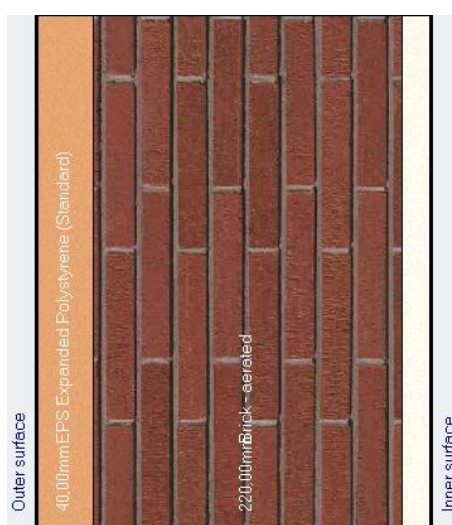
Materiais usados na parede como visto no *DesignBuilder*: isolamento na parte externa, depois tijolo e reboco na parte mais interior.
